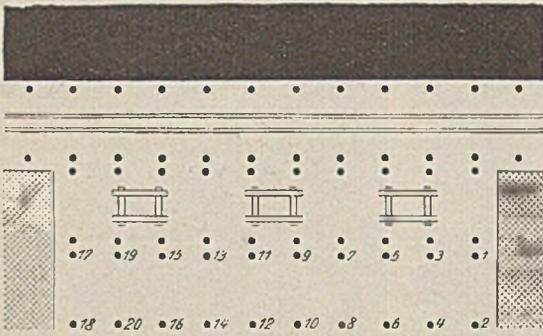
Rauben der Stempel hinter den Holzpfählern.
